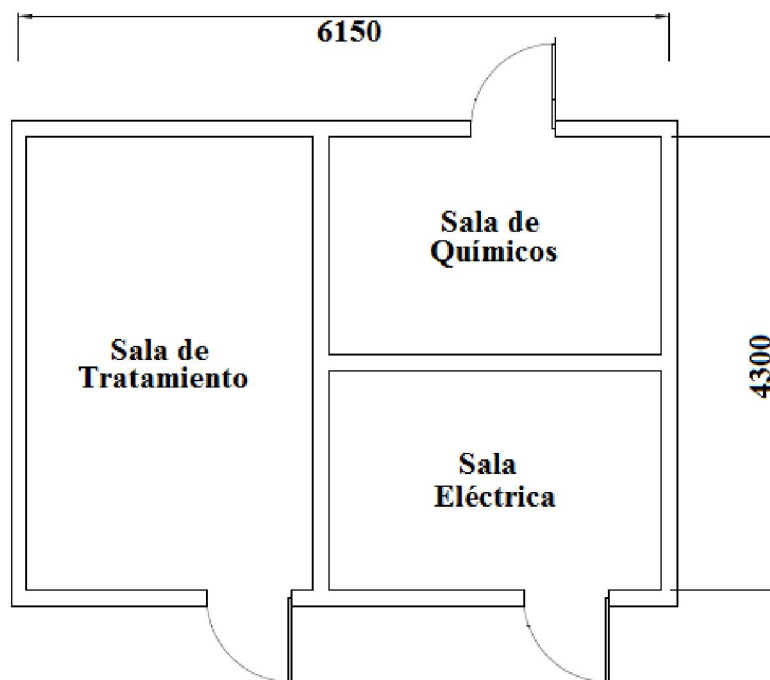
Esquema general de la planta de tratamiento (vista en planta)
